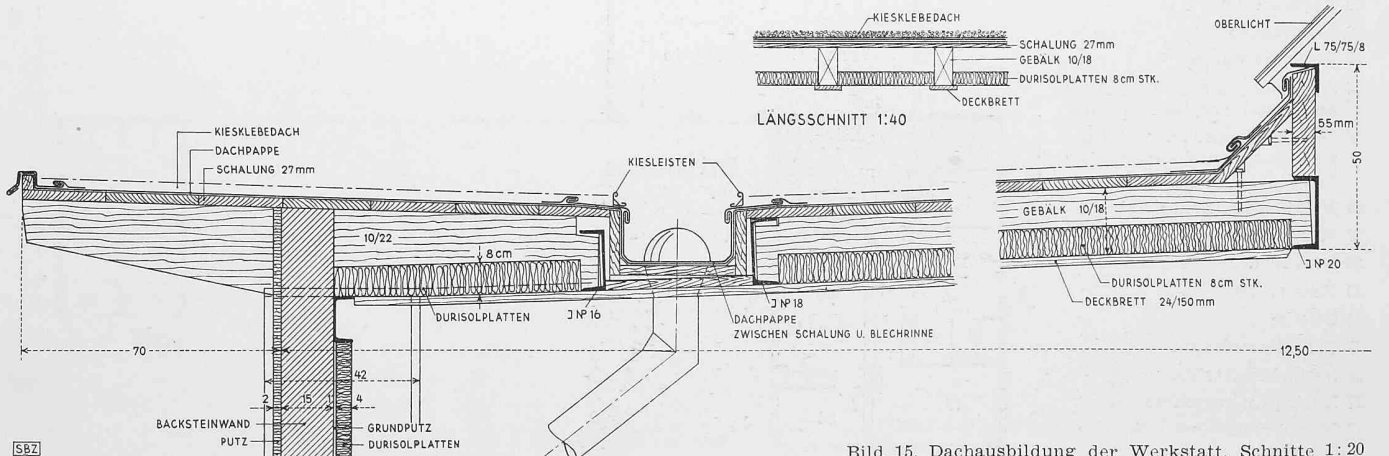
Dachausbildung der Werkstatt, Schnitte 1:20
